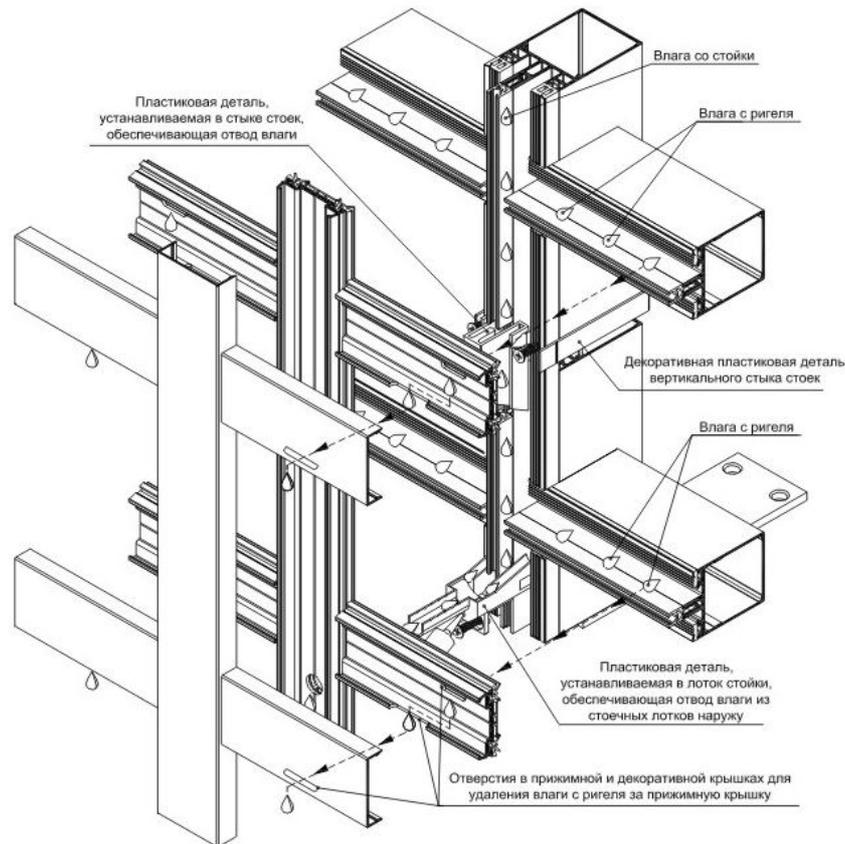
Системы водоотвода и вентиляции стоечно–ригельного фасада IF50.
